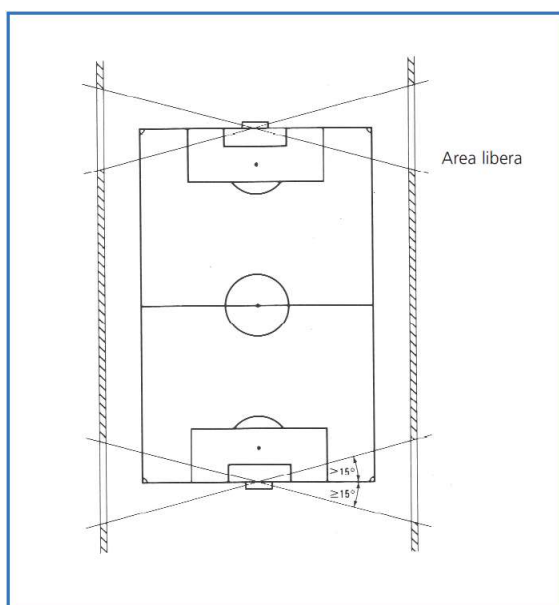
Disposizione su coperture spalti lungo le fasce
